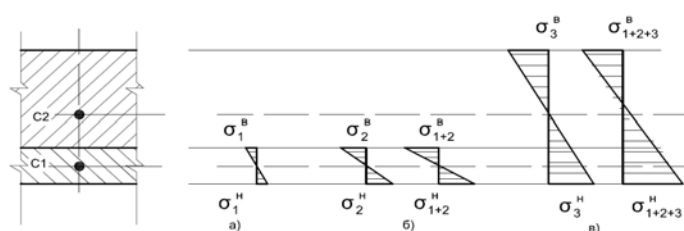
Епюри зміни напруг у збірній залізобетонній плиті опалубки
